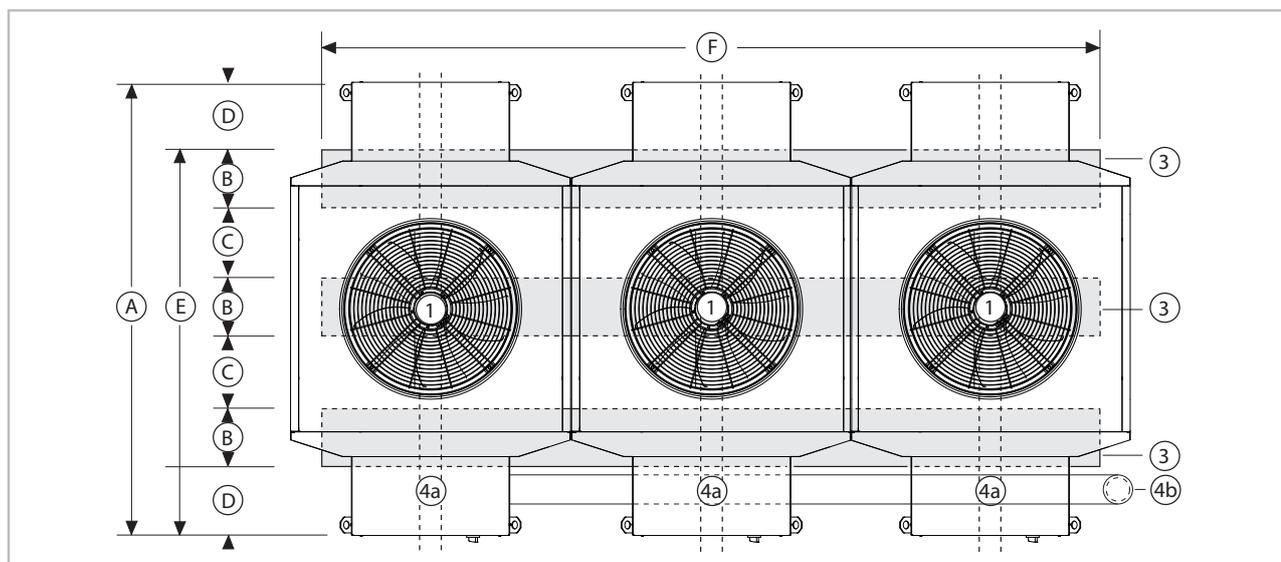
Dimensions des semelles filantes (vue de dessus)
